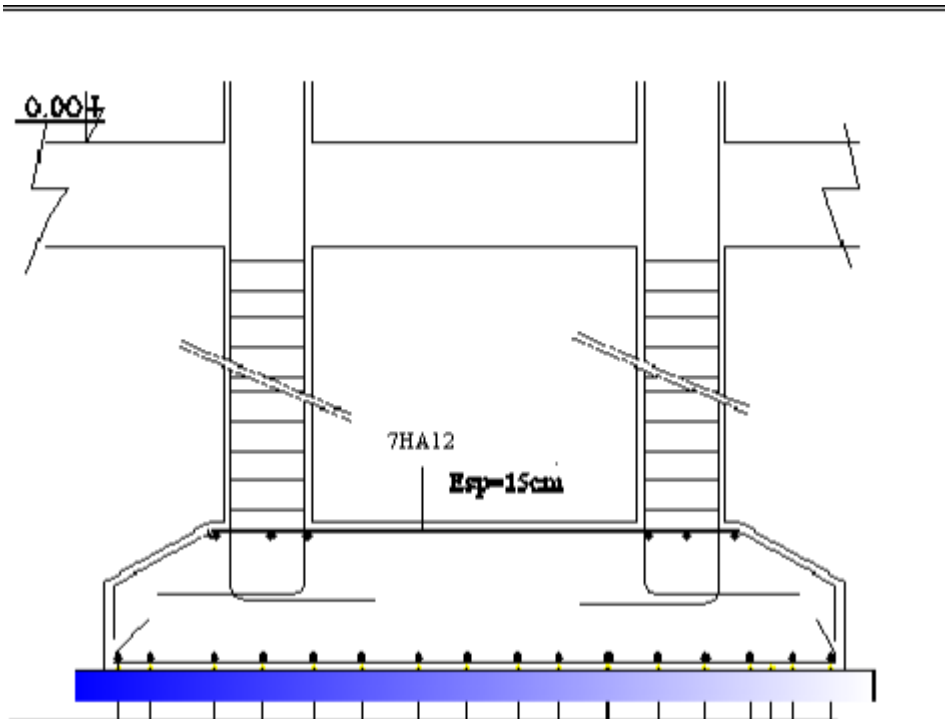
Exemple du ferailage de la Semelle filante sous deux Poteaux
